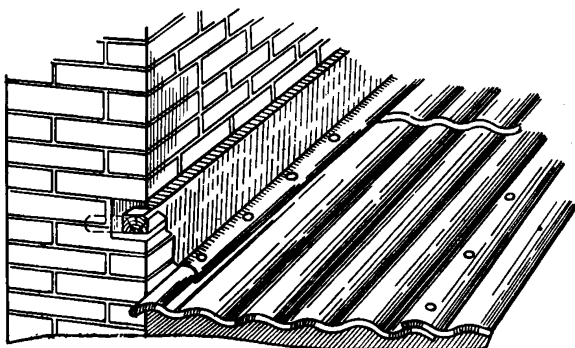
Устройство примыкания ската кровли из волнистых асбестоцементных листов к стене
